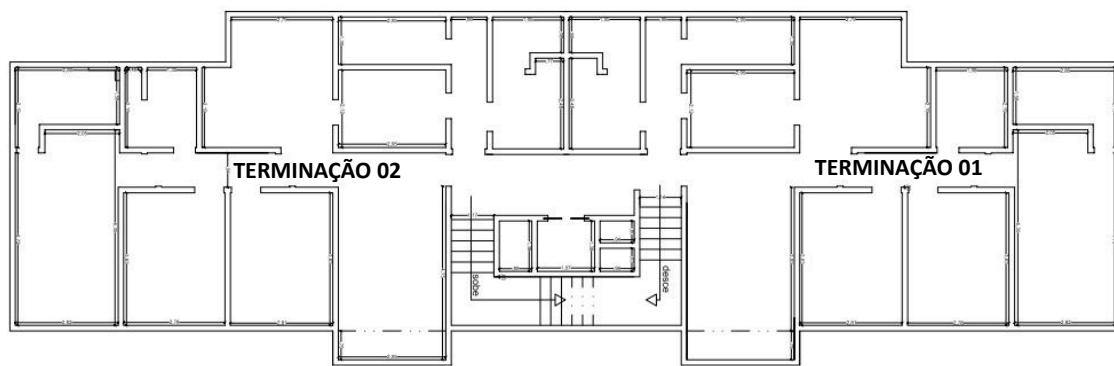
Planta Baixa (croqui) - Pavimentos 1 ao 5 - Blocos A, B e C.
